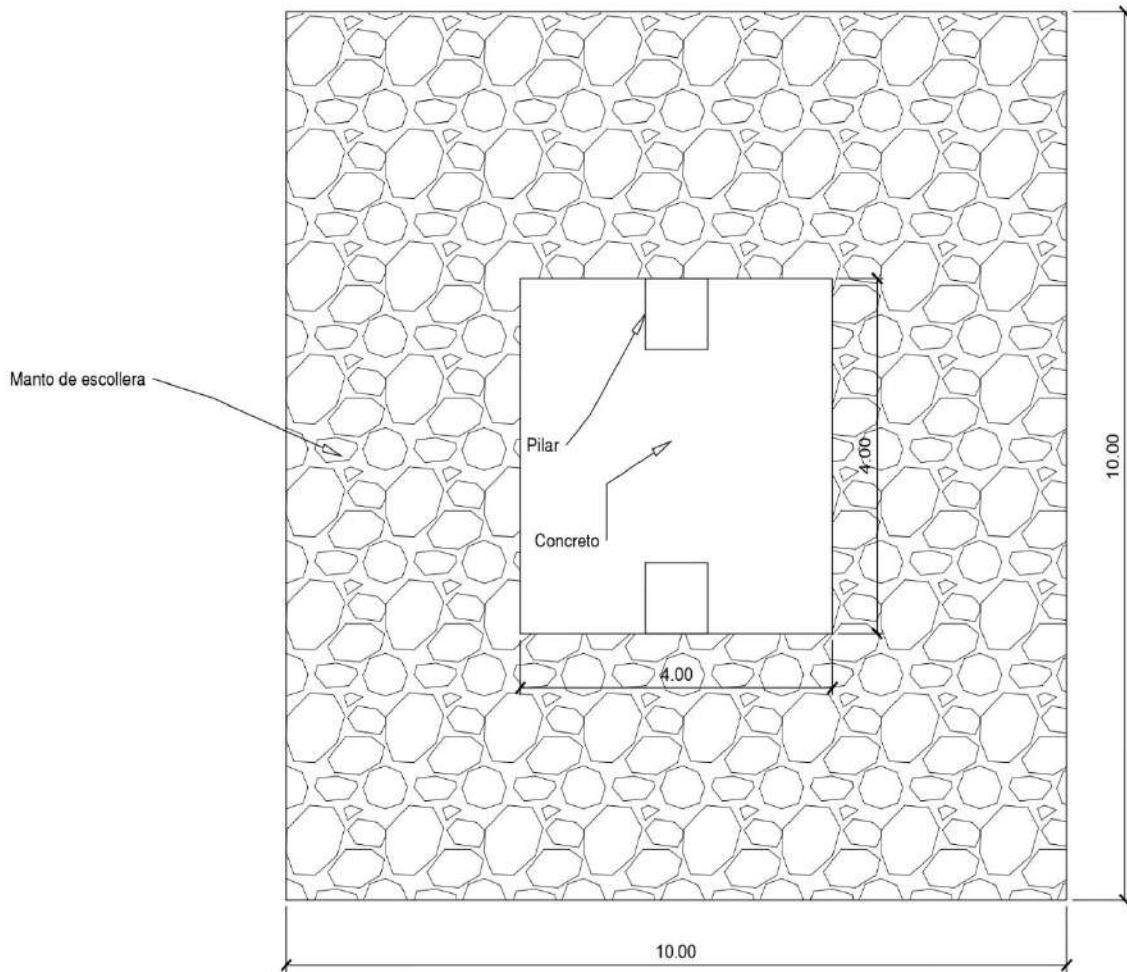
Dimensiones de manto de escollera en pilares 1, 2, 8 y 9, vista en planta
